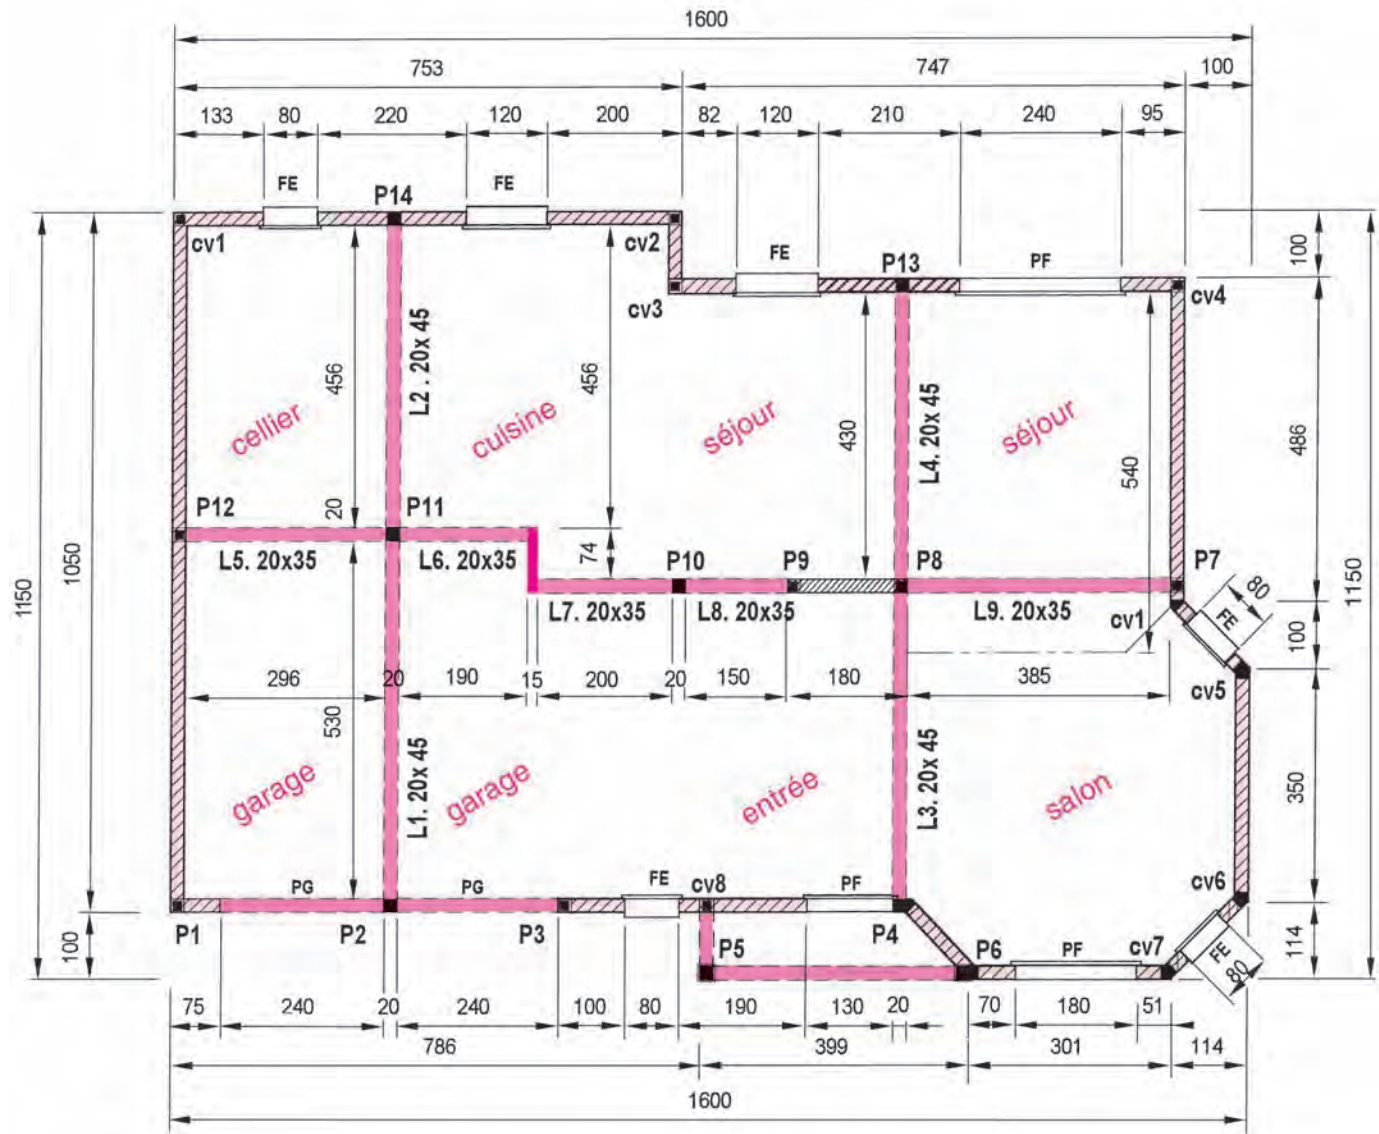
Plan de repérage des murs et poteaux, des chaînages verticaux et des poutres
